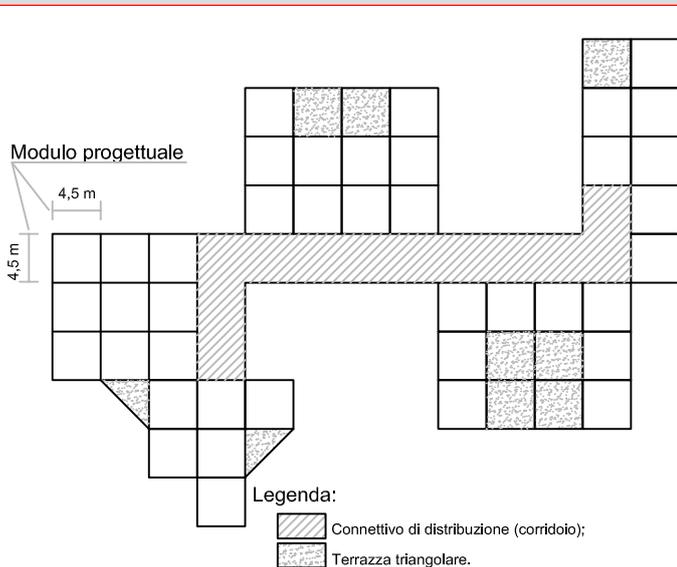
Schema di organizzazione planimetrica mediante corridoio.
